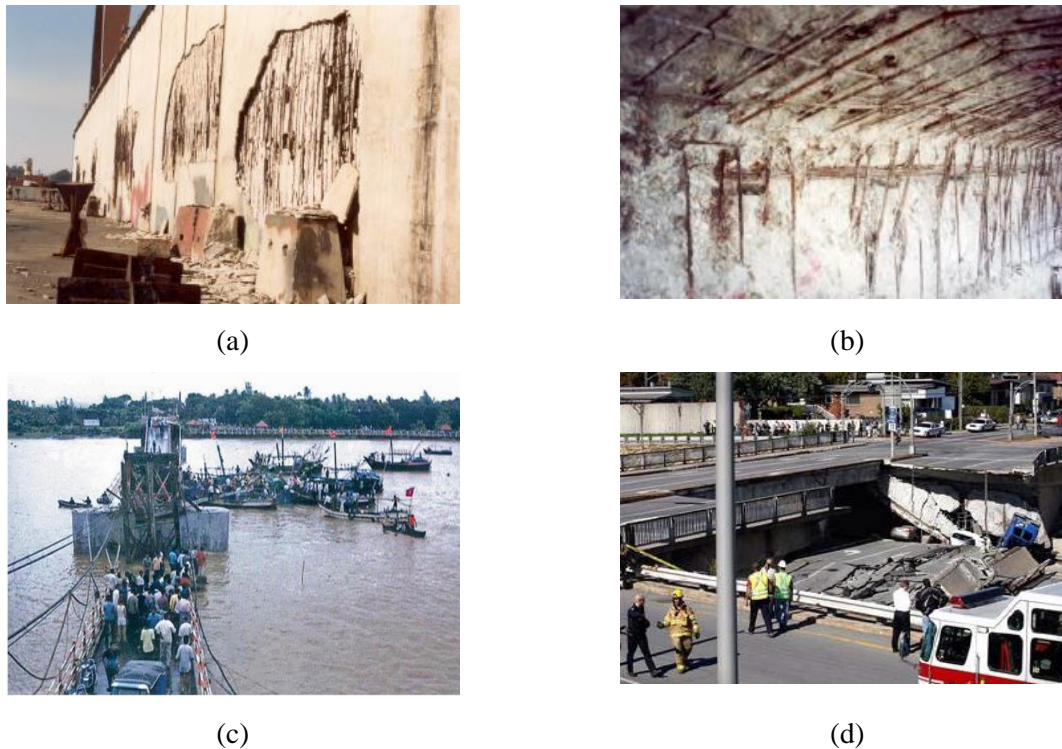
Deterioração muito precoce de estruturas: a) Docas de Lisboa; b) Interior de uma ponte do cais (LISNAVE) [2]; Colapso de estruturas: c) Colapso da ponte Daman, Índia (2003); d) Colapso de um viaduto (5 mortes), Canada (2006) [3].
